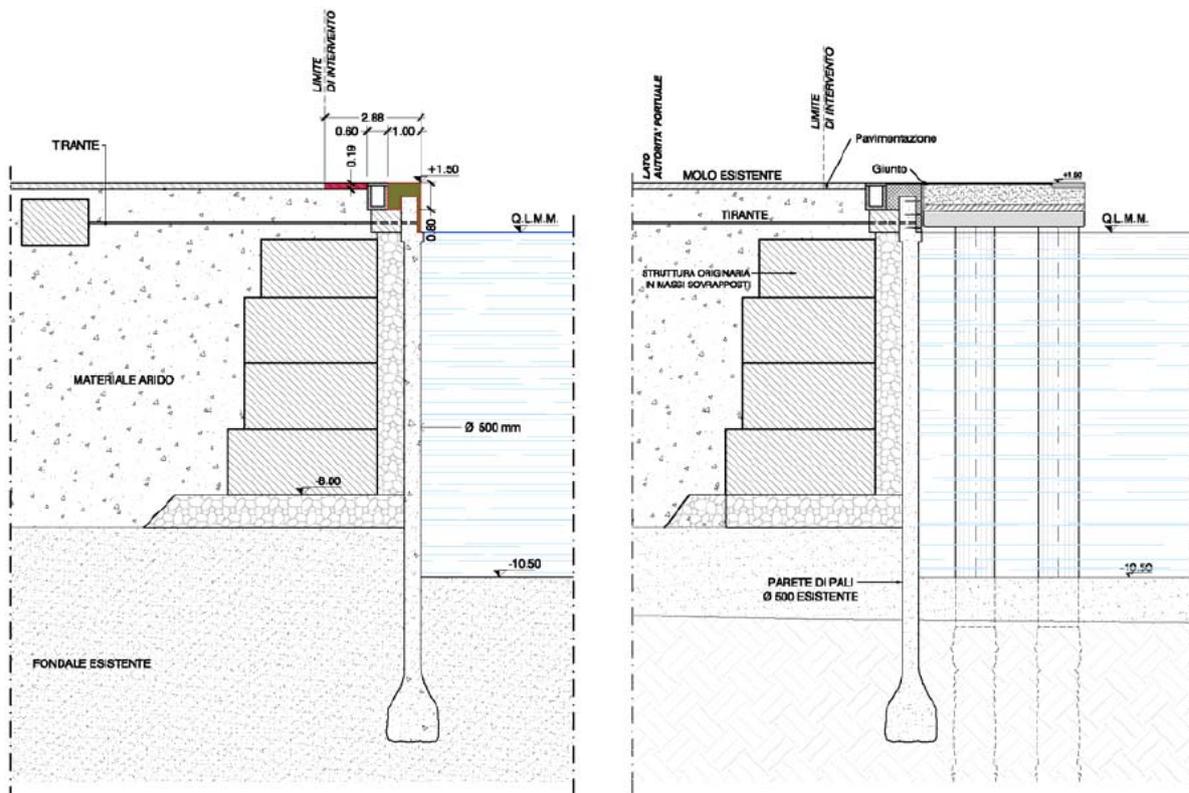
demolizione e ricostruzione tratto di banchina esistente in massi sovrapposti e palancolato in calcestruzzo
